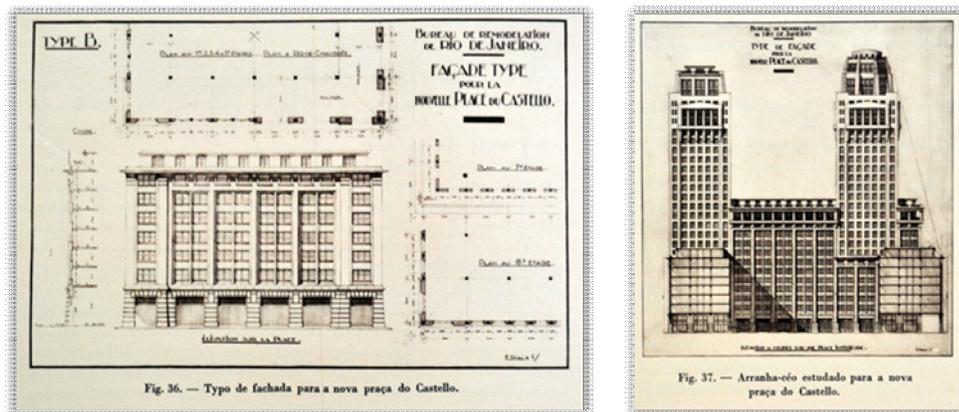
Tipo de fachada e Arranha-céu para a nova praça do Castelo
